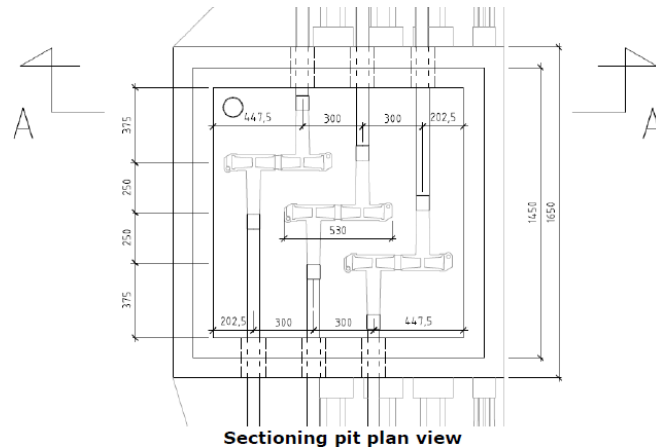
Vista in pianta dei giunti sconnettabili all'interno dei pozzettoni di sezionamento
